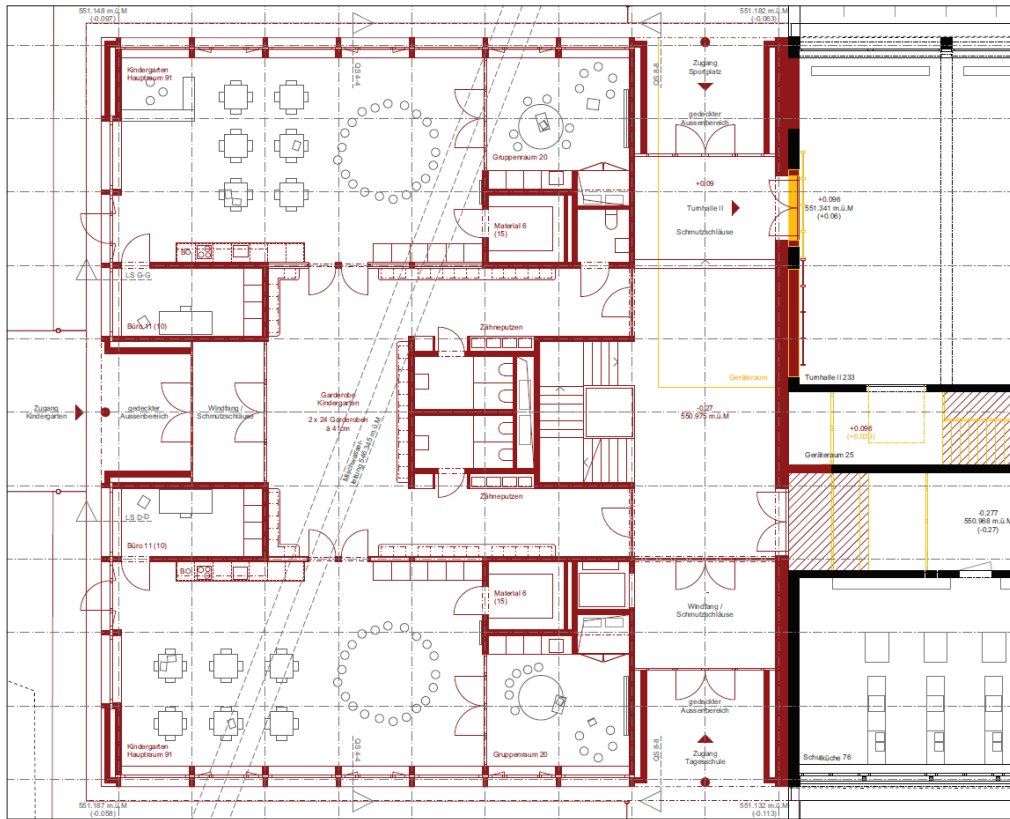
Grundriss Erdgeschoss mit zwei Kindergärten
